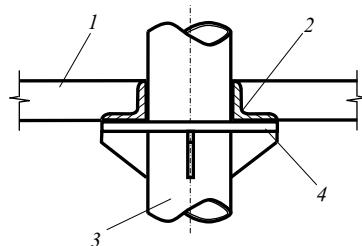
Схема вузла з'єднання надколонної плити сталезалізобетонного безбалкового перекриття з трубобетонною колоною
